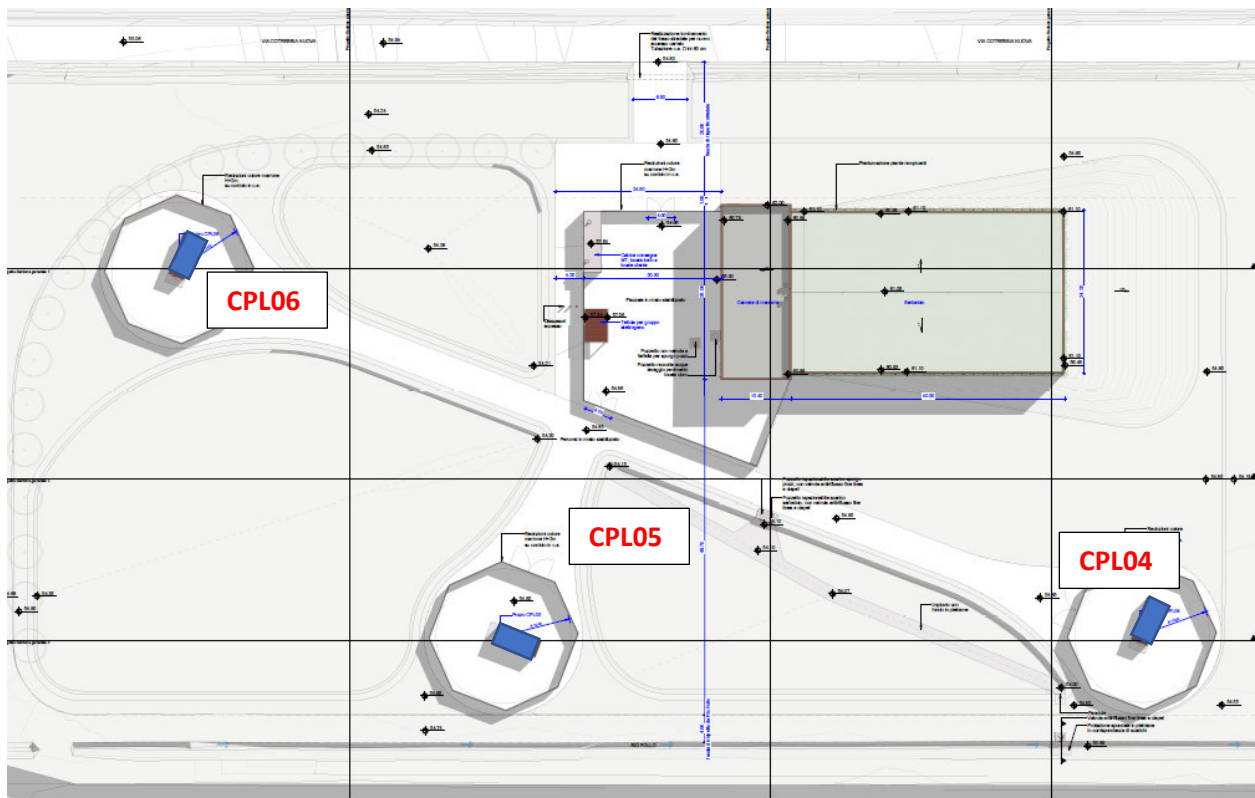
Planimetria centrale con in blu i pozzi in progetto.
